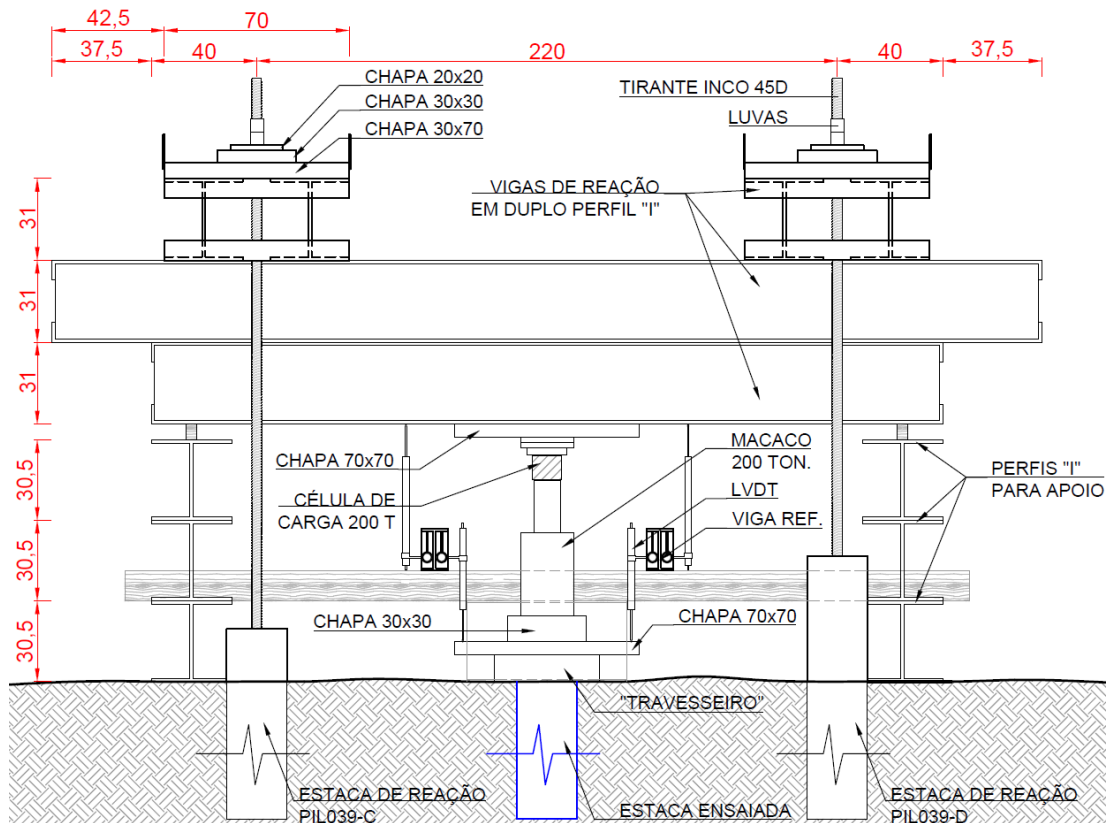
Vista frontal do sistema montado para execução da prova de carga.
